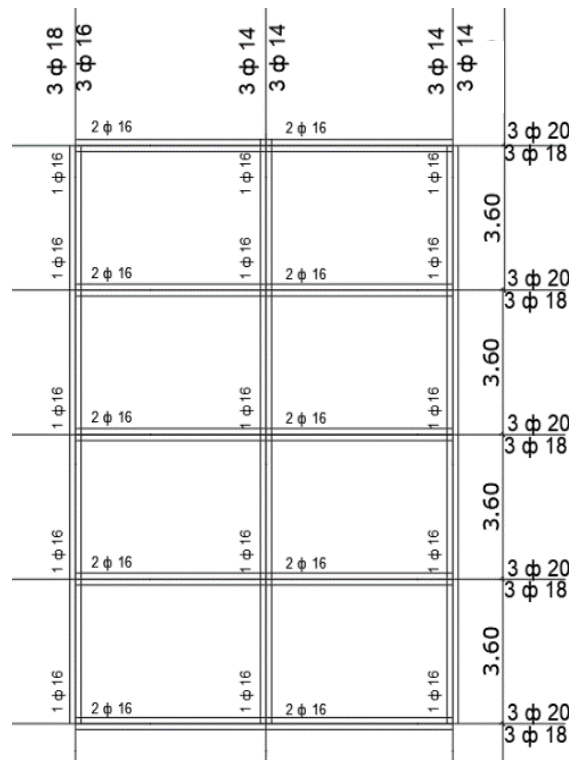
Esquema de Armado. Fuente: Autoría Propia.
